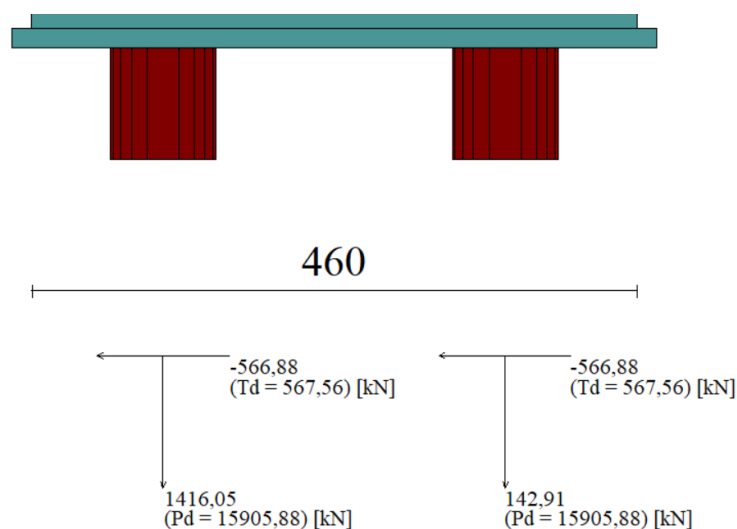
Sollecitazioni massime a testa palo dei MURI DI CONTRORIPA - FONDAZIONE SU PALI - TIPO 2
